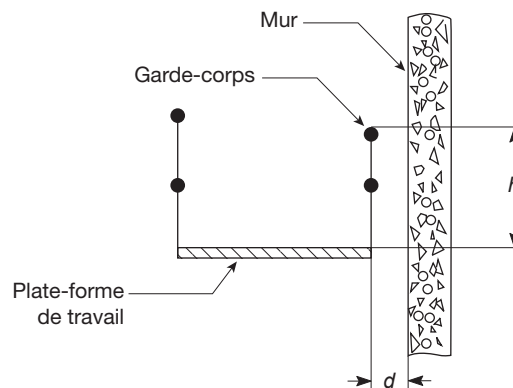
Dimensions des garde-corps côté façade des plateformes.
